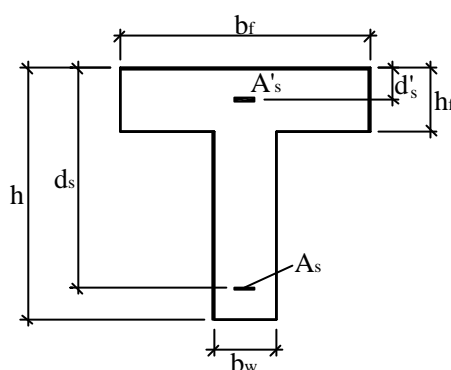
Seção transversal da viga sem considerar a armadura externa
